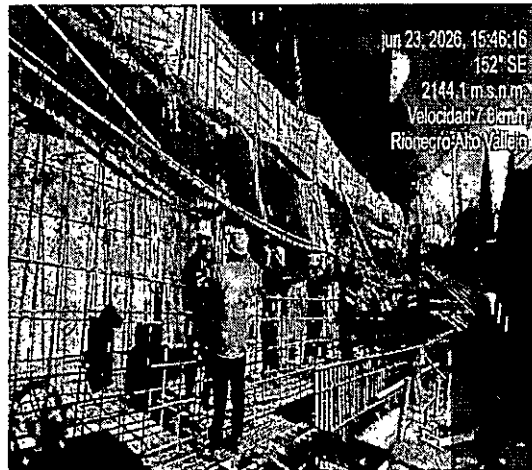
armado de refuerzo en elemento estructural zapata y vástago.
